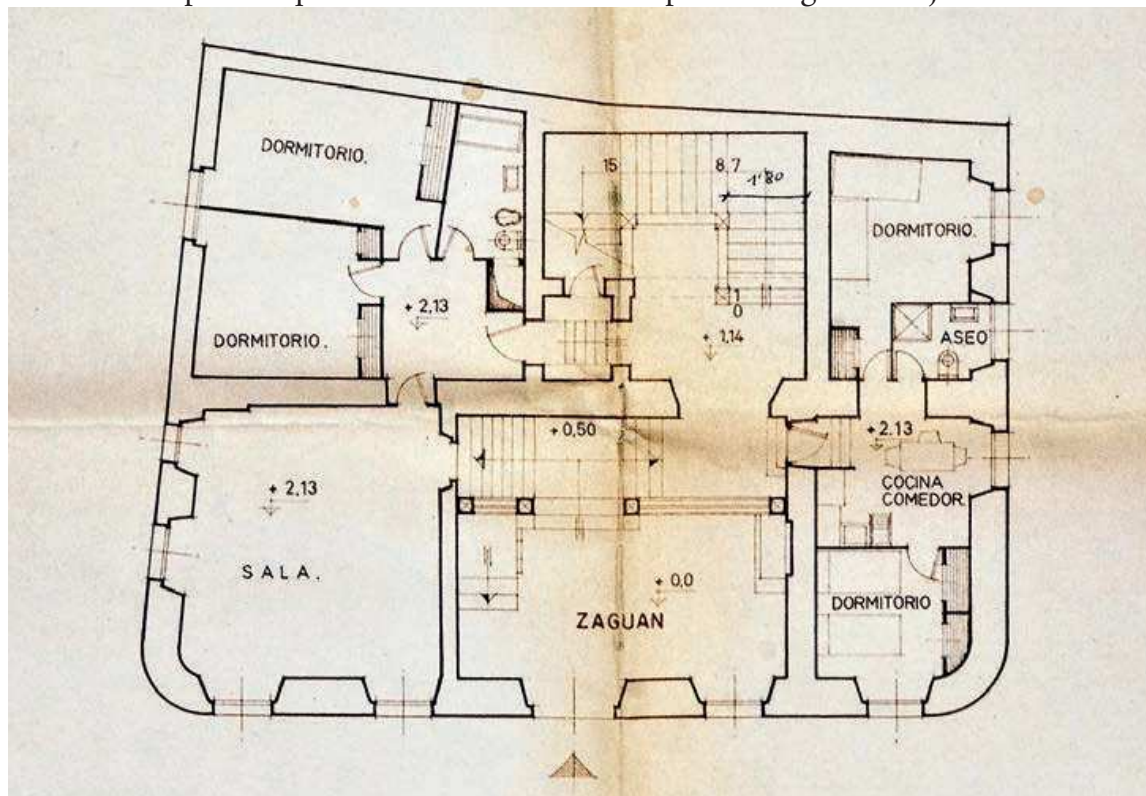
Planta baja del proyecto de reforma de la Casa Cornide. Ca. 1762. AMC. Planos Extraídos-Alcaldía-Correspondencia C-6529 (11). Casa de Los Tomasinos-Casa Cornide, n.º 1155. Foto Caruncho
